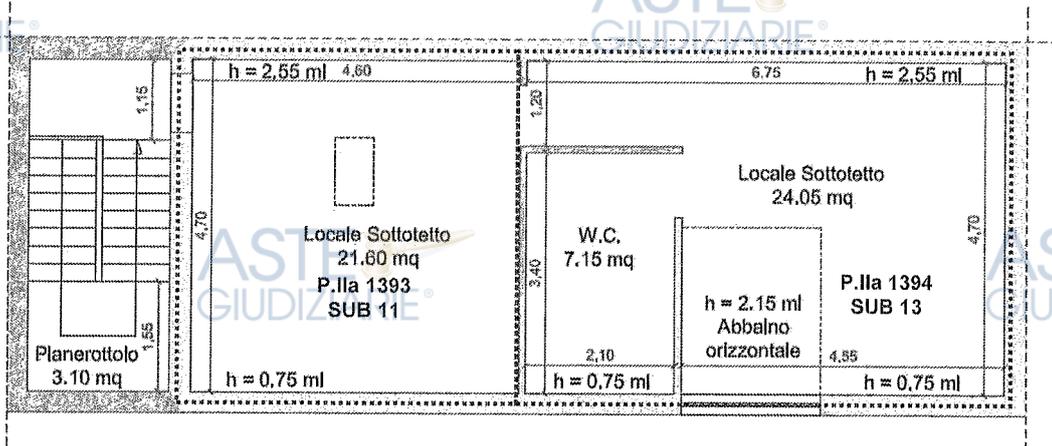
Planimetria Stato di Fatto Foglio 47, p.la 1393, sub 11 e p.la 1394, sub 13 (graffate tra di loro) – Piano 2
